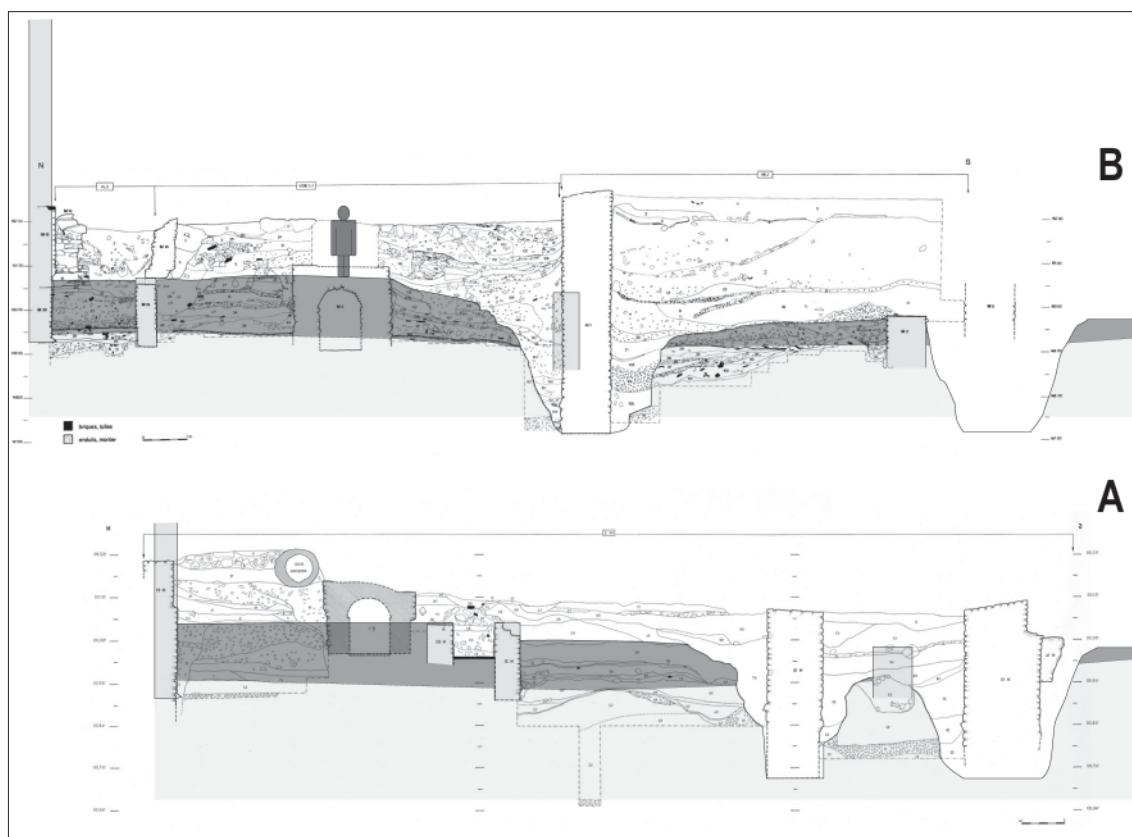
Les tranchées de fondations du Portique Nord. (J.-L. Prisset)
